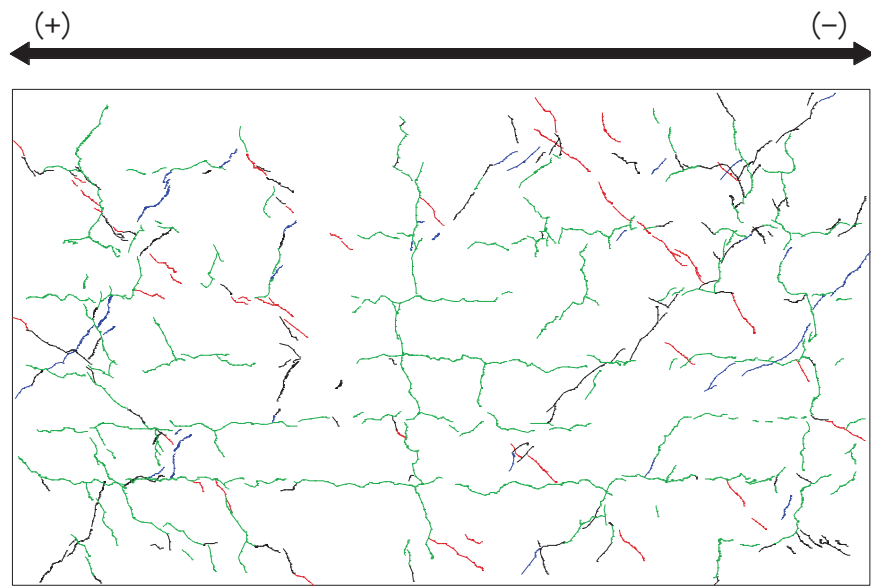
(6) 乾燥試験体 [2] 1/1667rad. におけるひび割れ図
